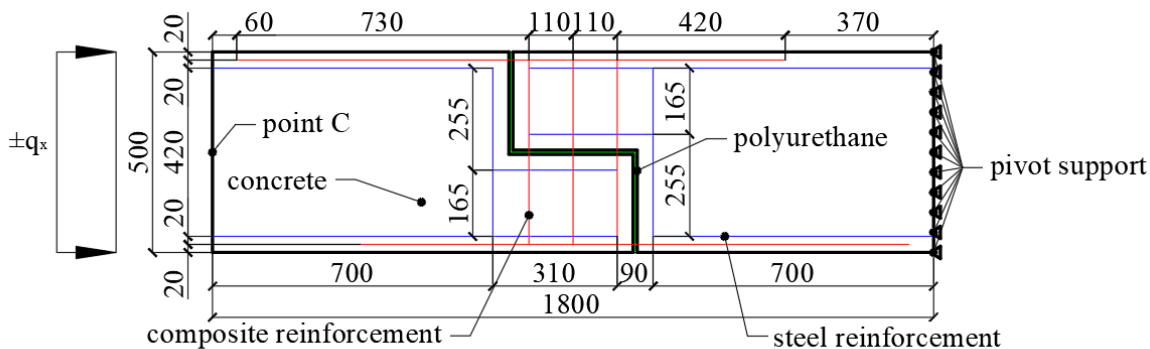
Составная железобетонная балка. Сжатие – растяжение.
